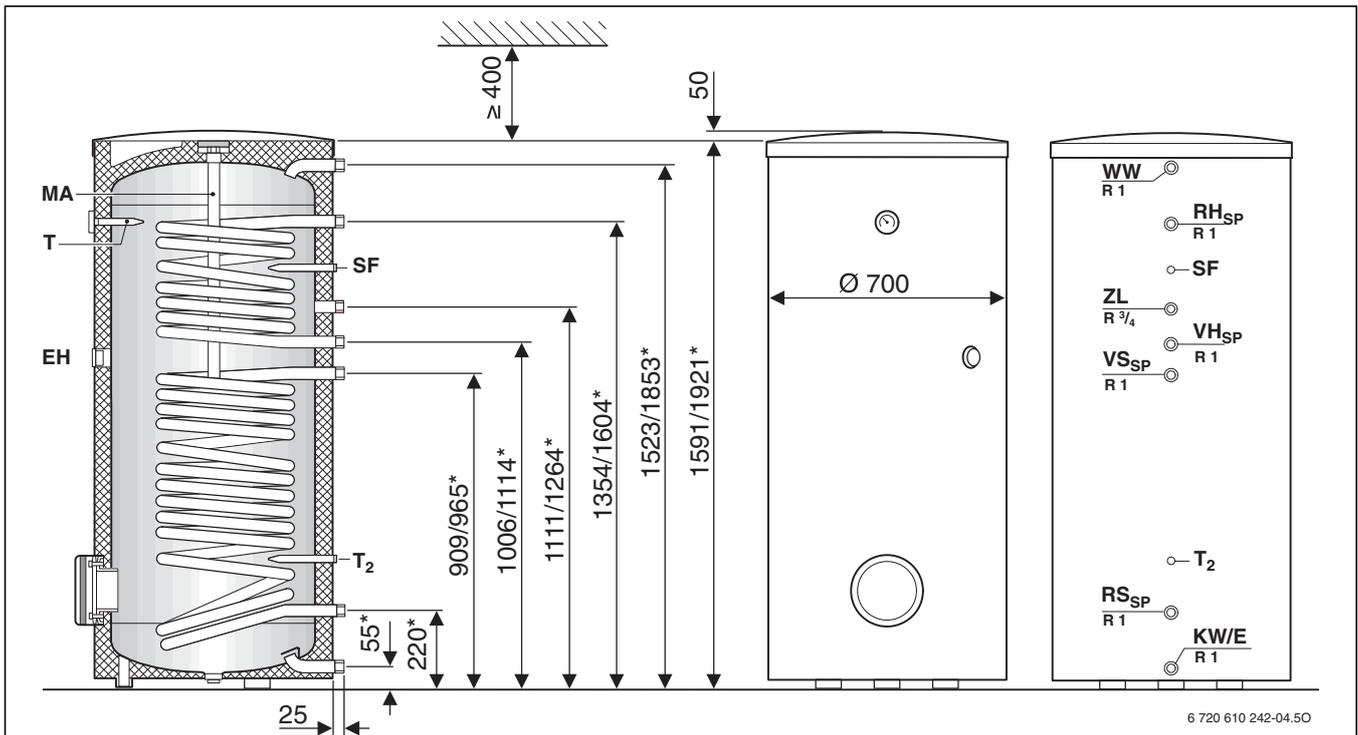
Bau- und Anschlussmaße SK 400/500-1 solar
